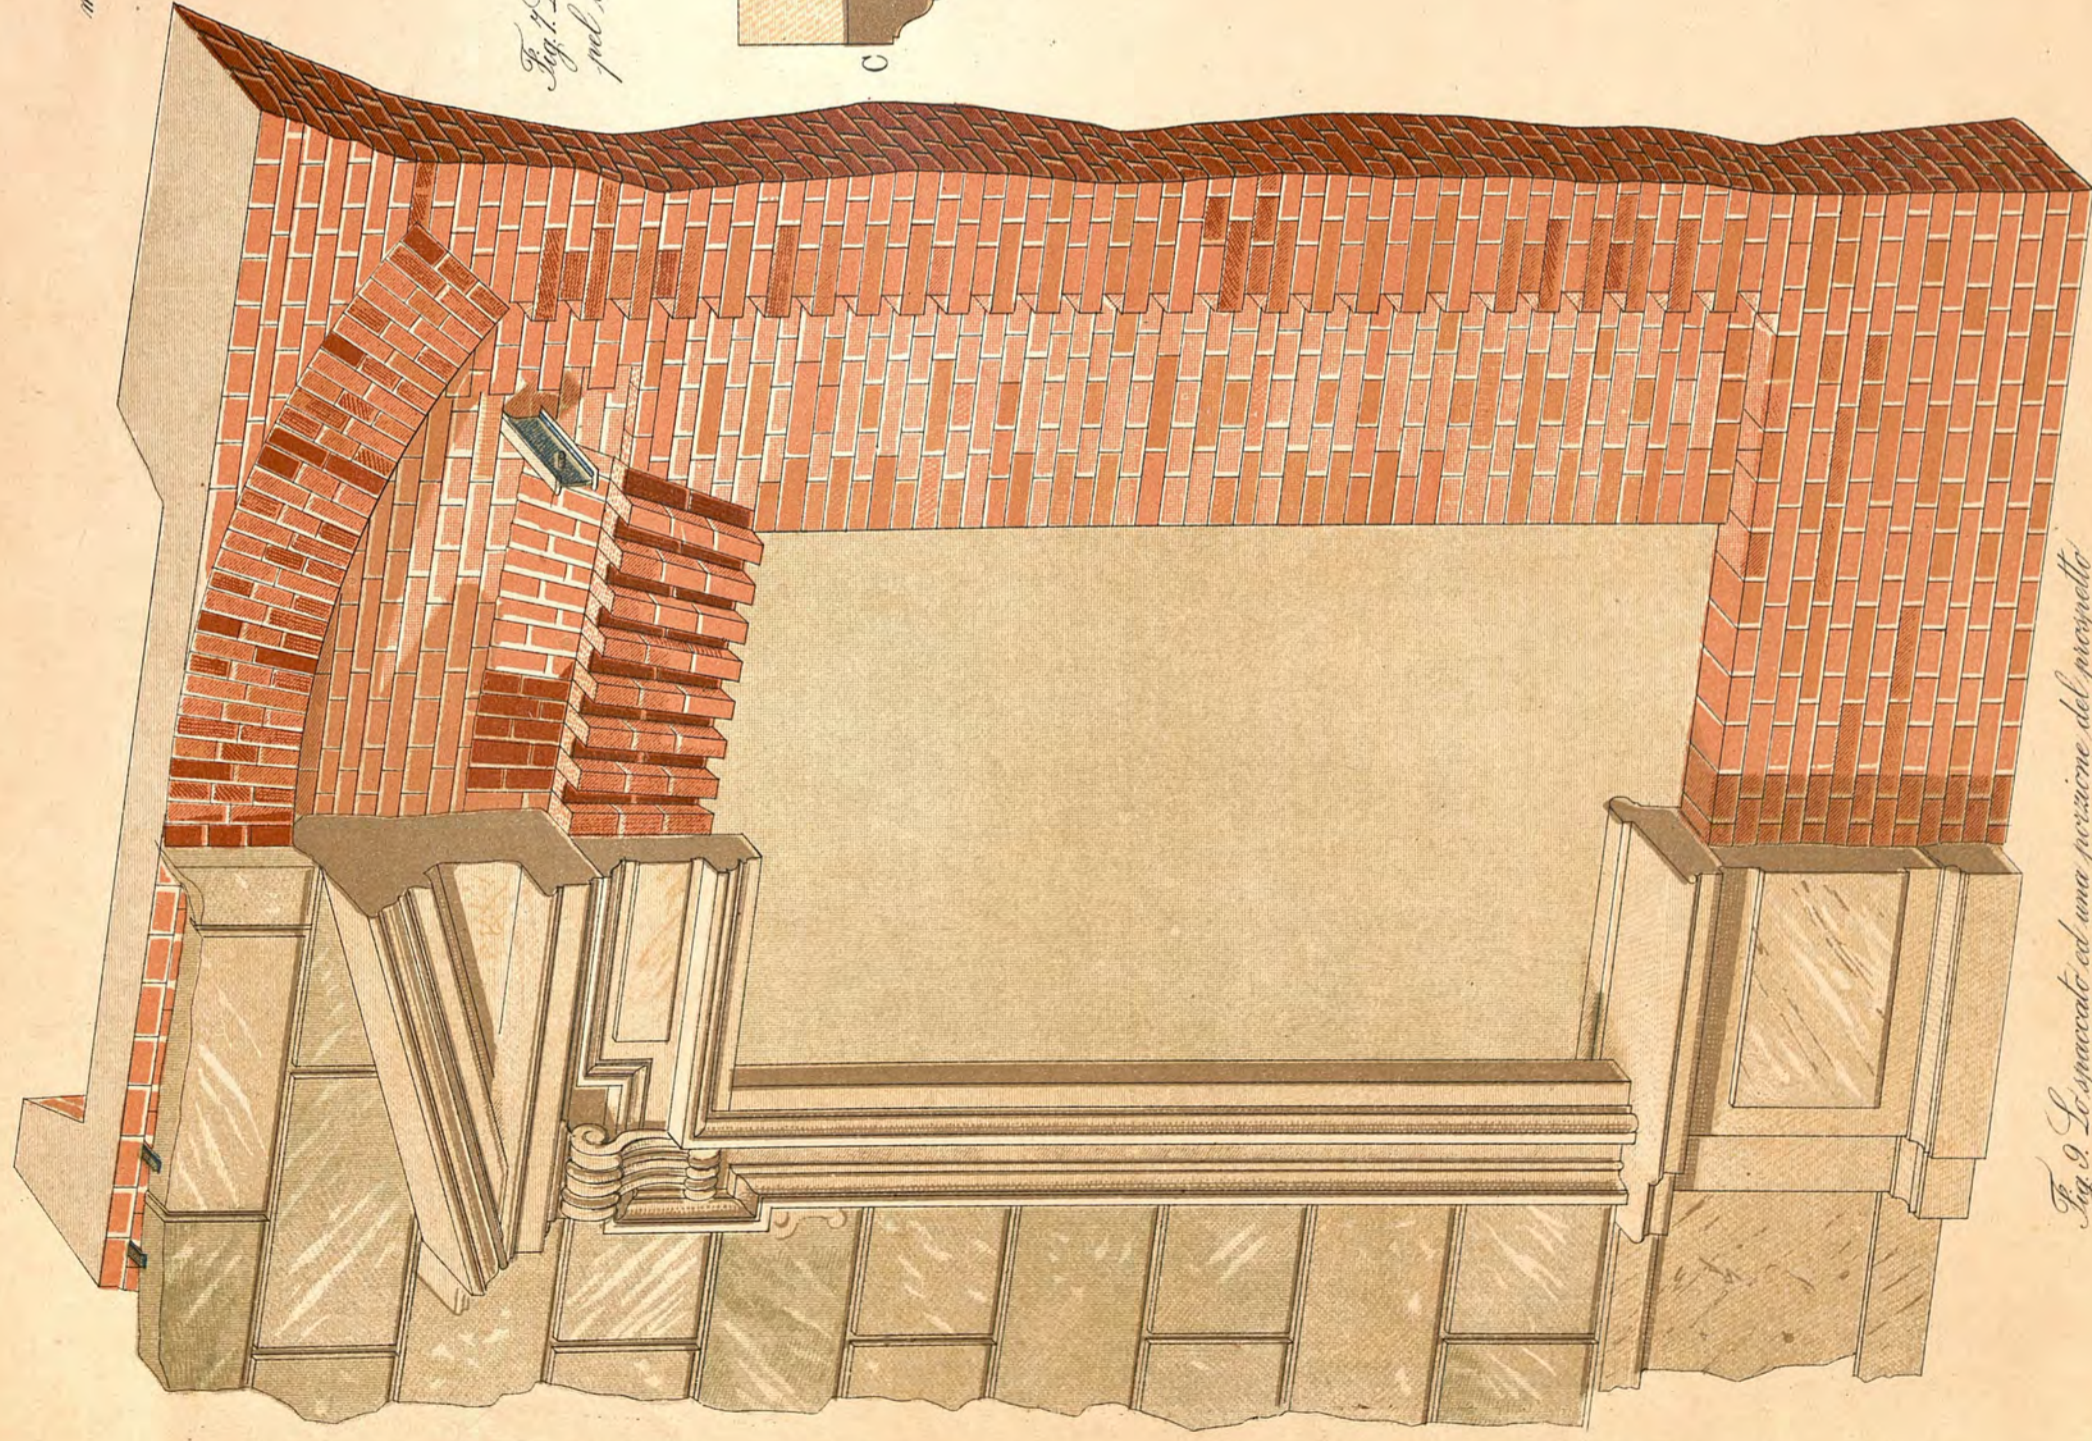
Lo spaccato ad una porzione del prospetto delle pietre col rustico del muro
